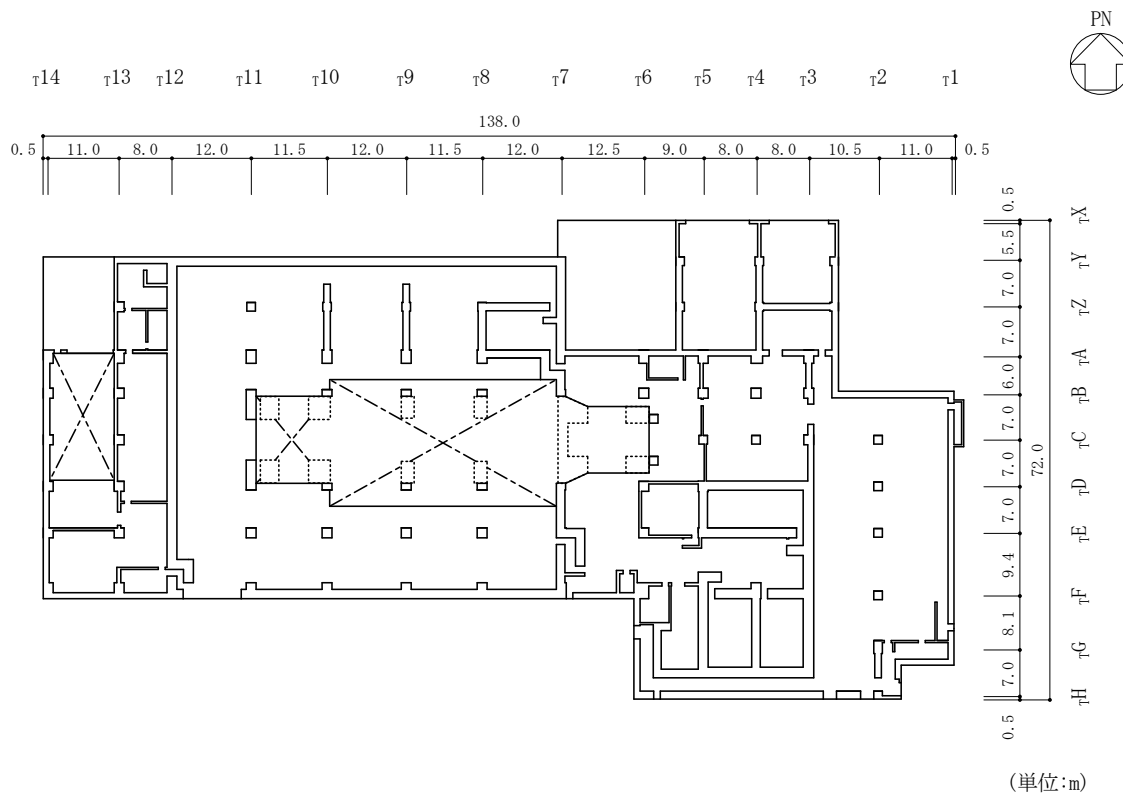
(1) タービン建物の概略平面図 (EL 12.5m)
